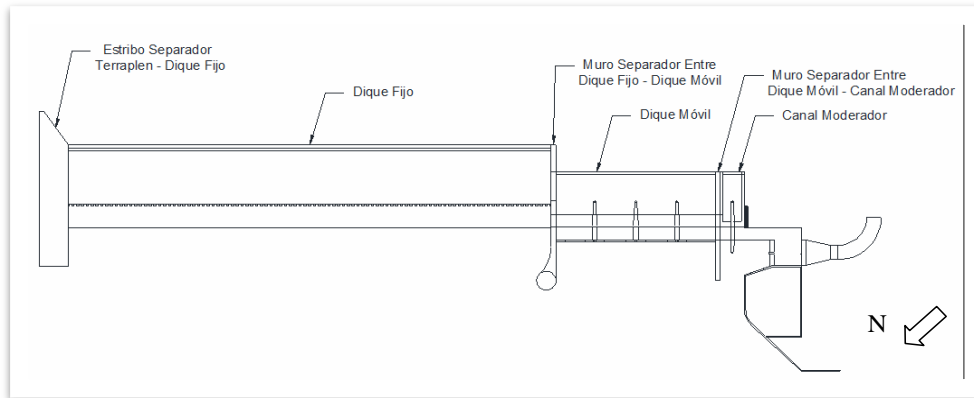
Esquema en planta de la construcción (Halcrow, 2010).
